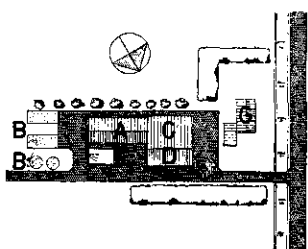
Plan G: erfindeling van een situatie met een vrijstaande woning
